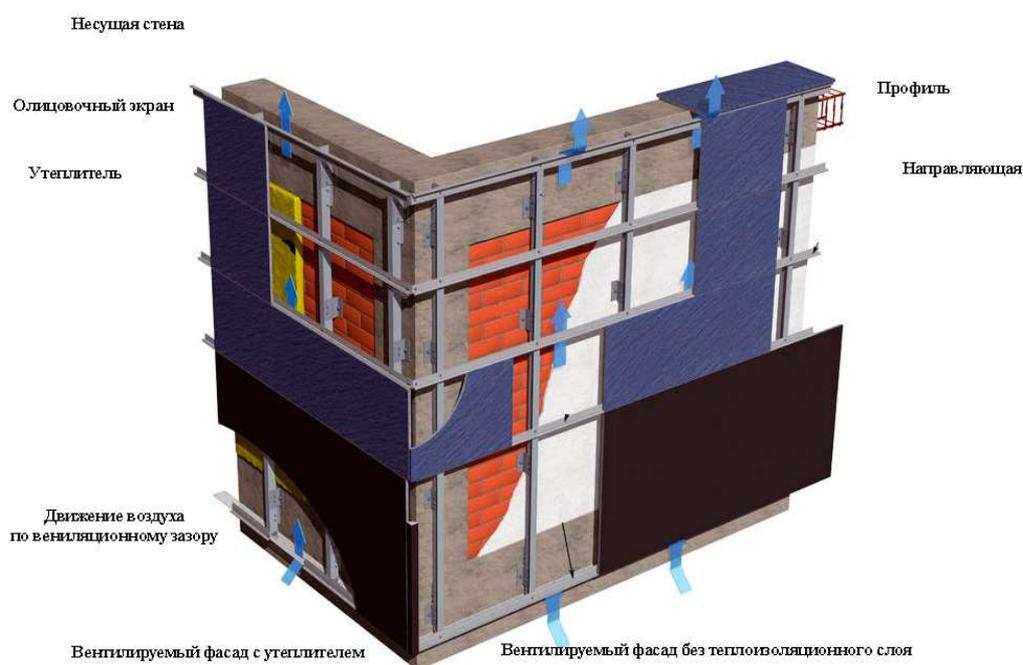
Реконструируемое здание с вентилируемым фасадом
